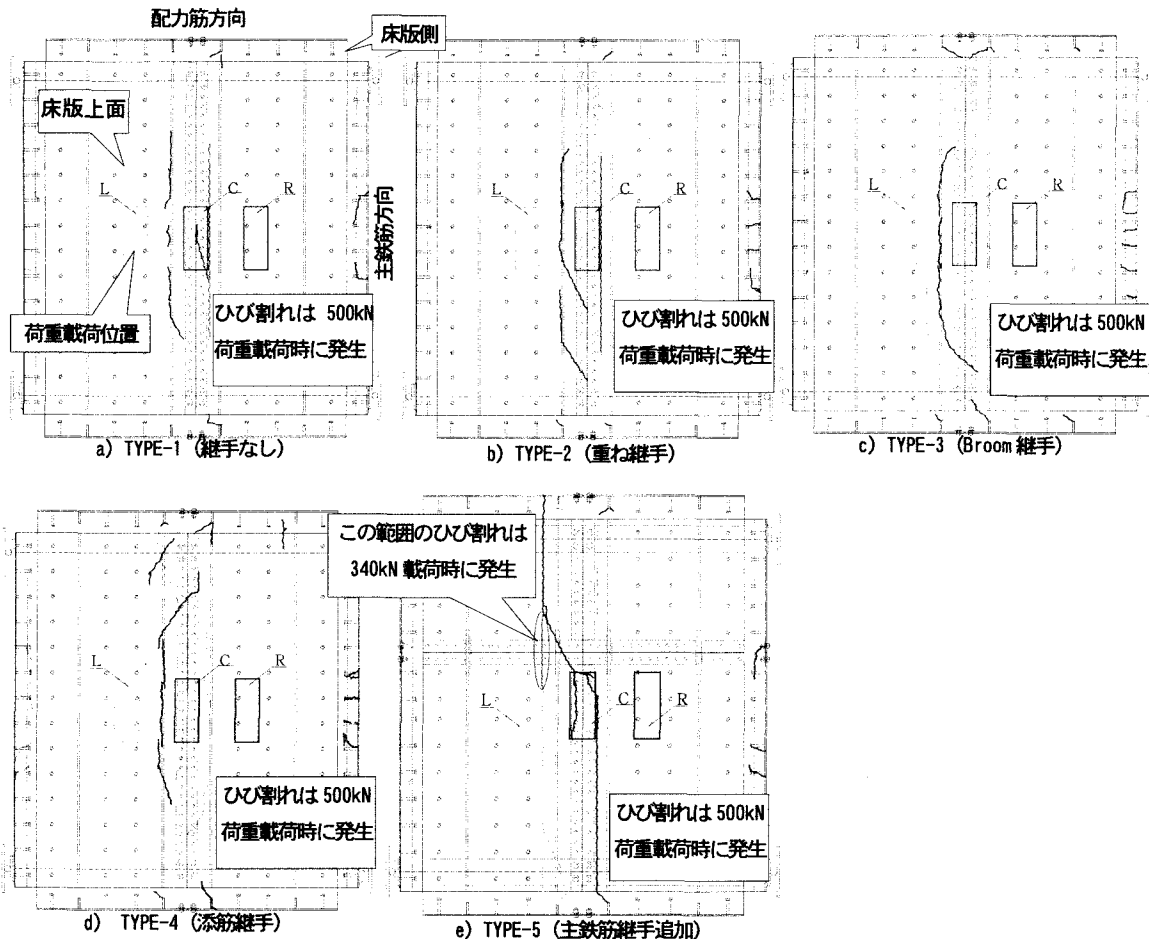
配筋の違いによる床版のコンクリートひび割れ性状の相違
